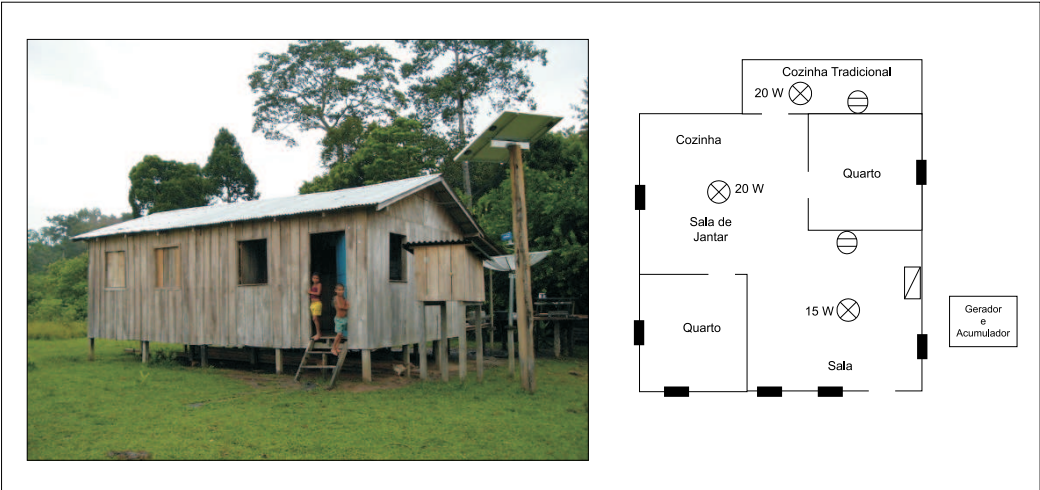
Vista externa do SFD11 e planta aproximada do domicílio.
